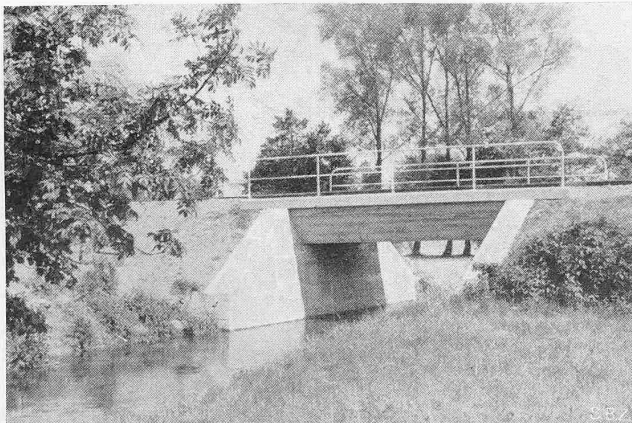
Eisenbetonbrücke über den Oeschbach bei Subingen Stützweite 6,0 m
